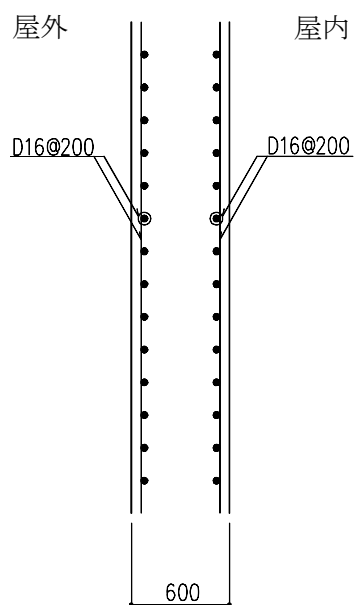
耐震壁の配筋図 (1階, YM通り X1~X2通り間) (単位: mm)
